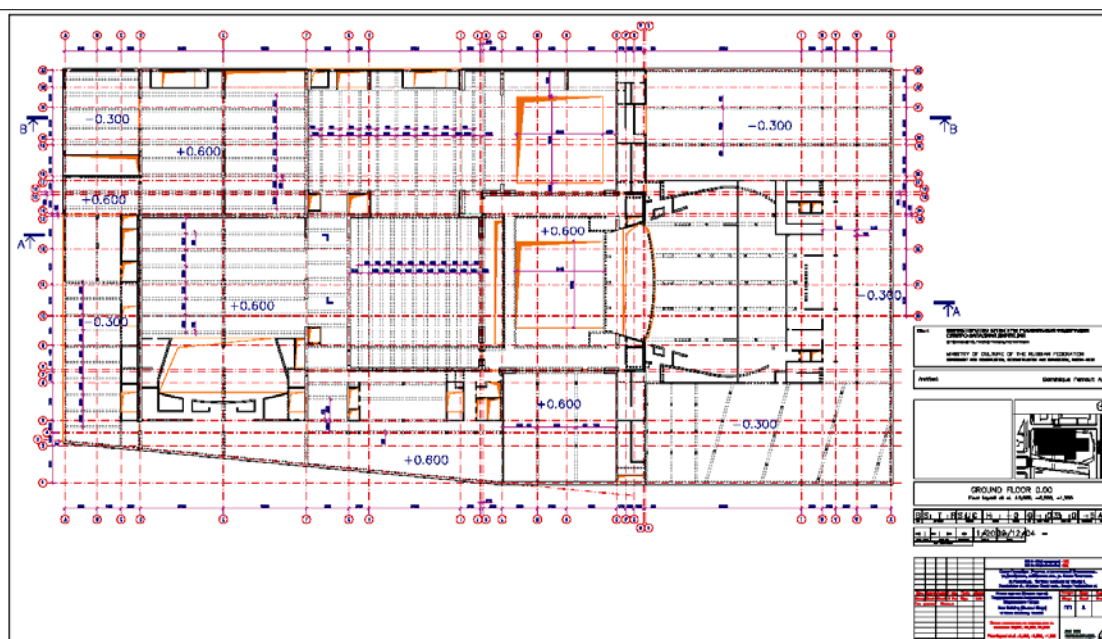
План перекрытия первого этажа с расположением несущих балок
